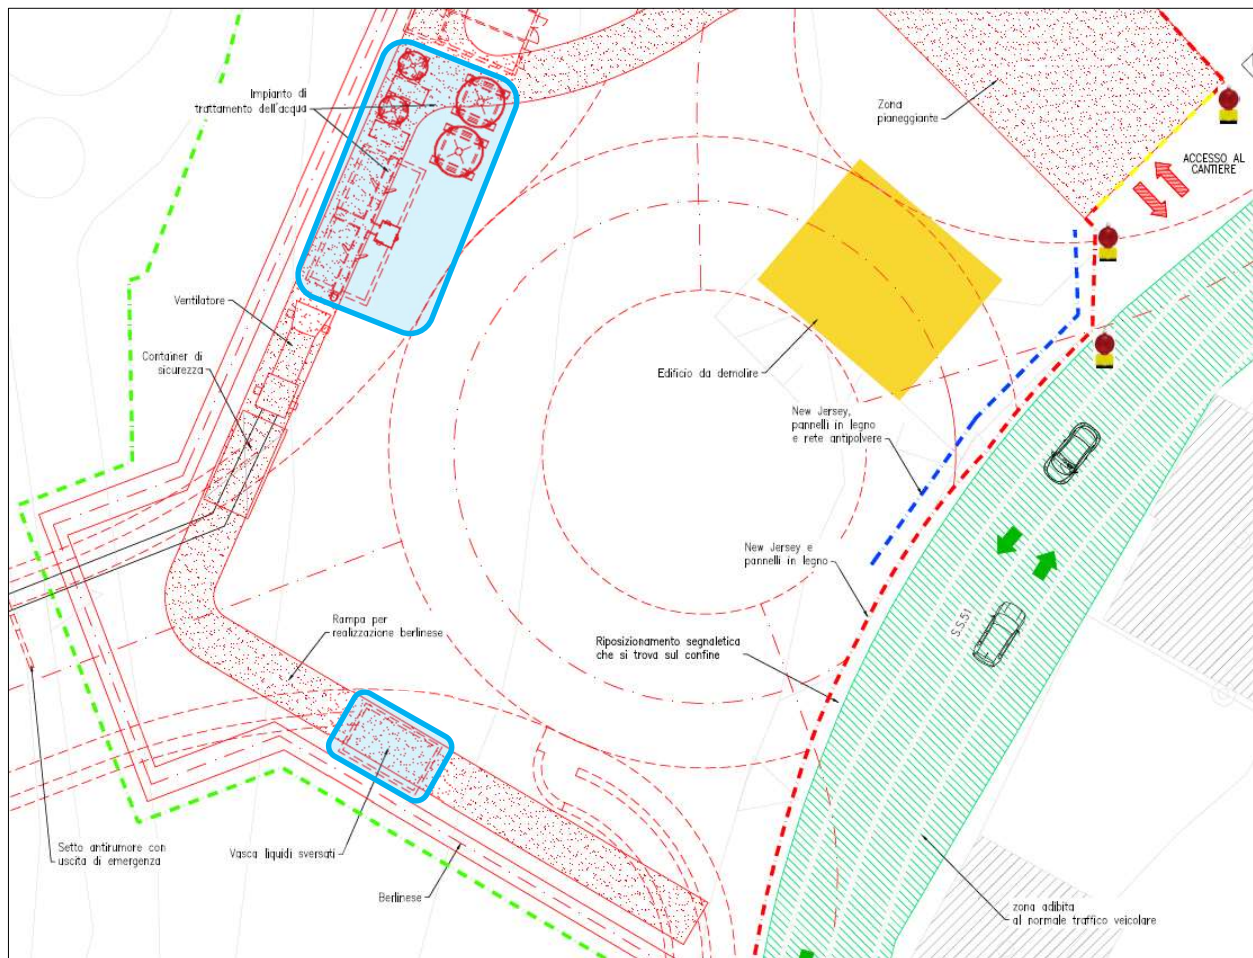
Layout cantiere 1 – vasca trattamento e vasca raccolta.
